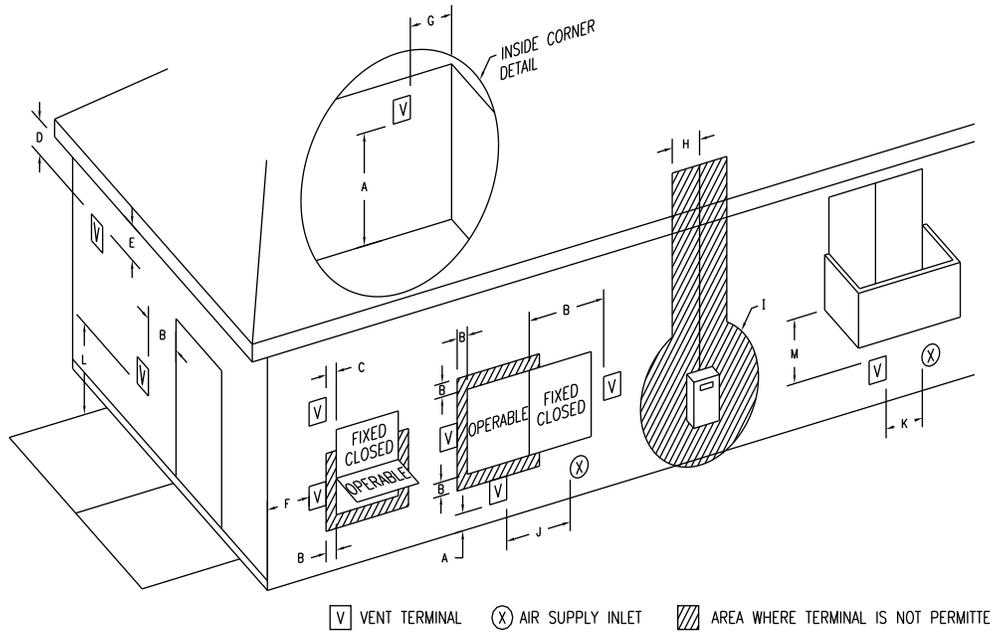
Dégagements des terminaux d'évent (autres que les installations à ventilation directe ou à ventilation directe forcée)
